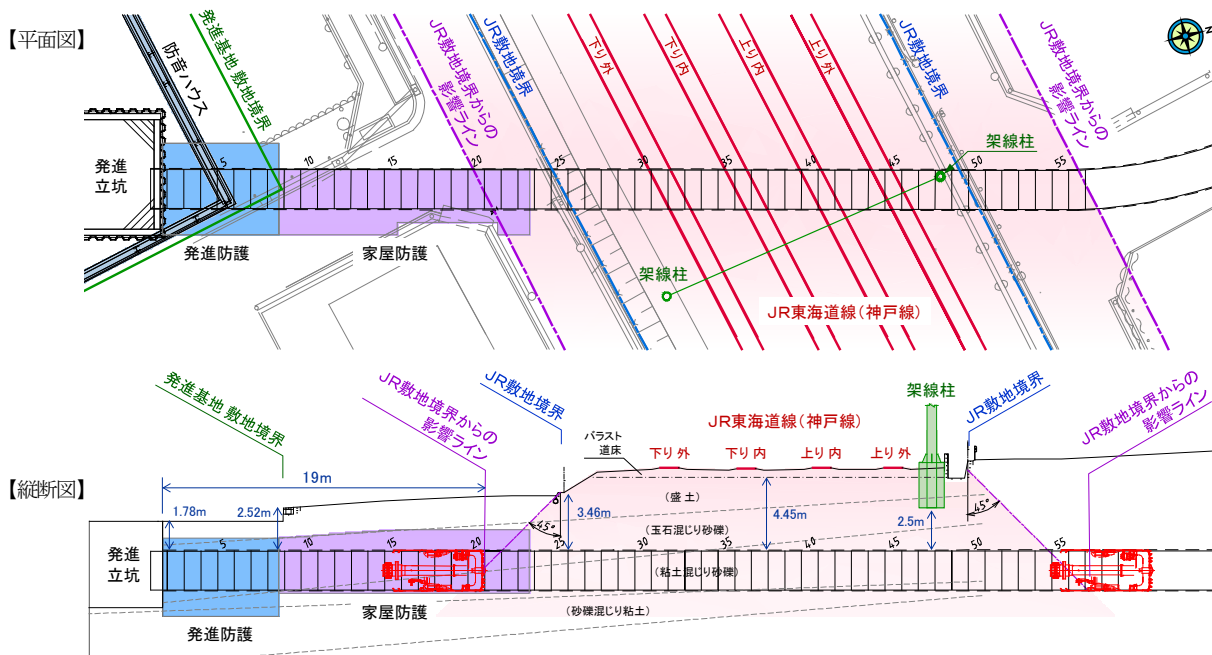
JR神戸線横断面部 概要図（平面・縦断面図）
